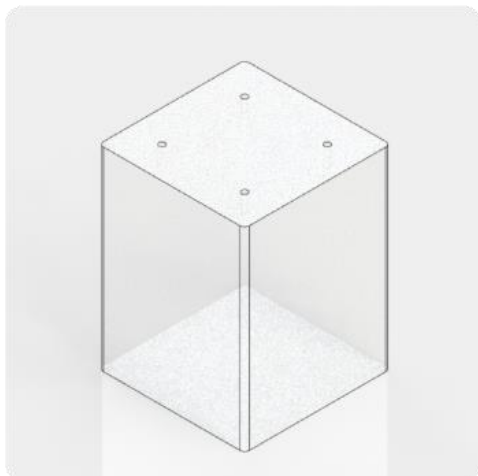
Cimiento en concreto para estructura de pérgola.
